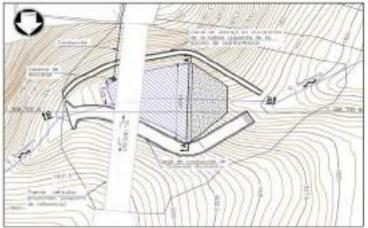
Vista en planta de la piscina de sedimentación de la quebrada Bochalema.
